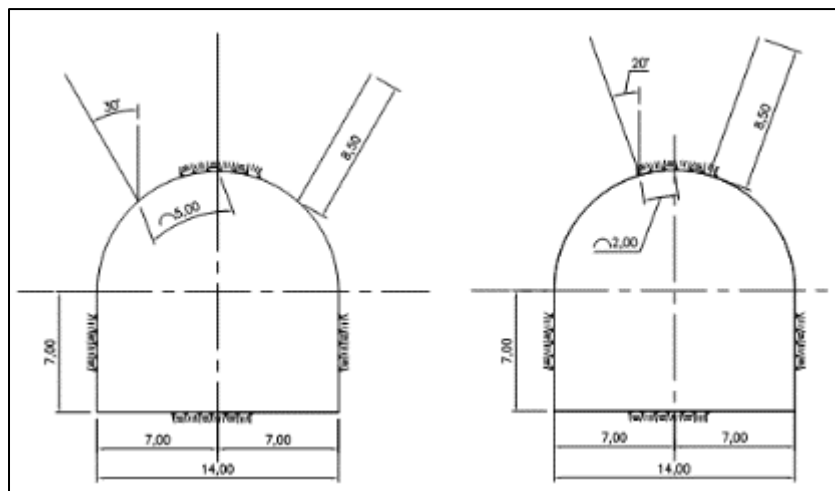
Esquema de furacão para as injeções de impermeabilização (adaptado de Intertechne, 2013)
